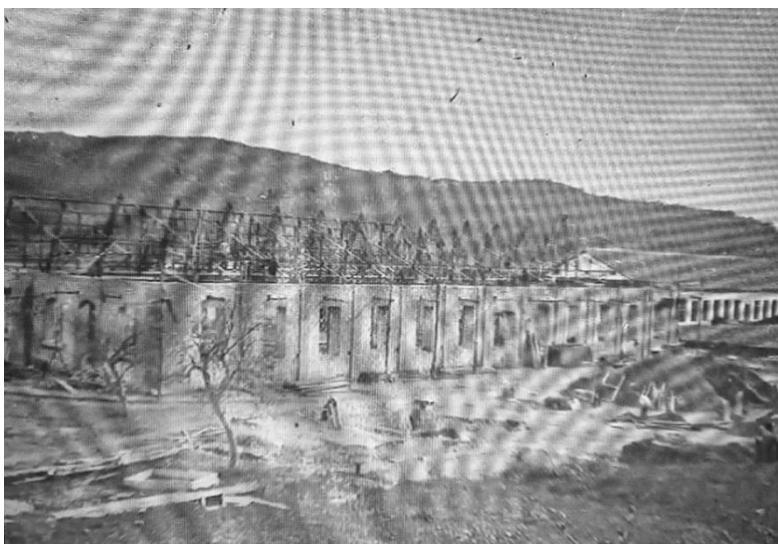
Edificio 'Dientes de sierra' – Tejido e hilados. Imagen exterior con la estructura construida.
